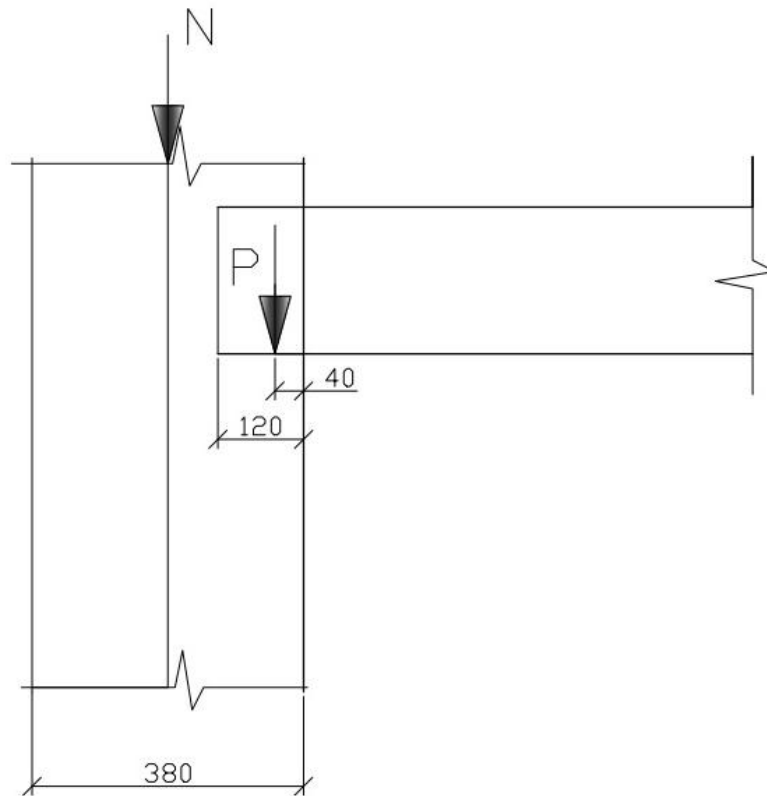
Схема опирания плит перекрытия на стену
